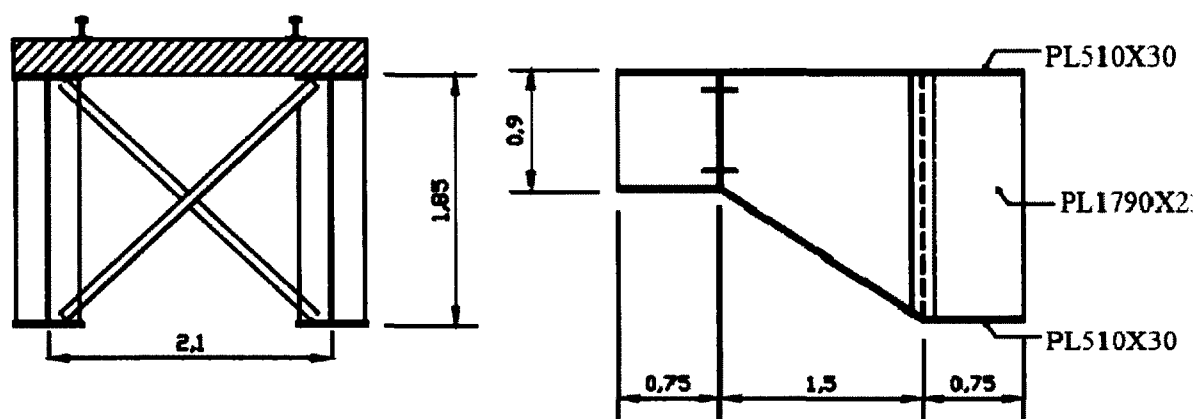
Pont bi-poutres - Section transversale et élévation - Section B
